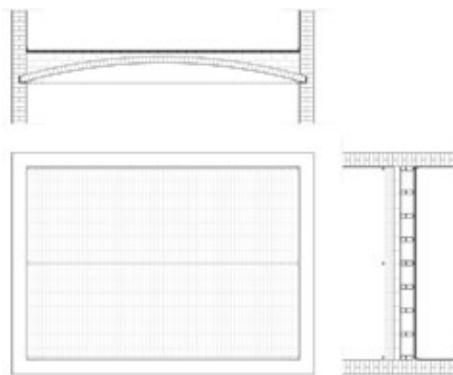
Detalle constructivo tipo de la solución calculada. Bóveda de BTC, formación de la superficie pisable, sistema de atirantado y encuentro con el muro.
